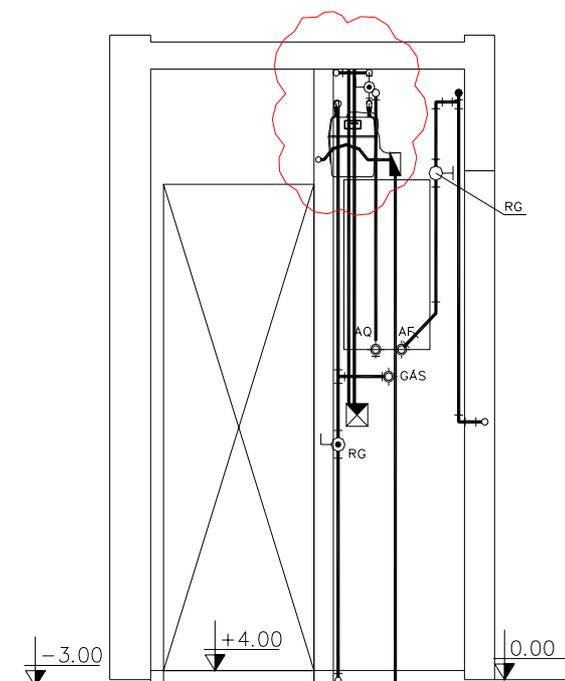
Elevação hidráulica da parede entre a área de serviço e WC no projeto de vedação.
